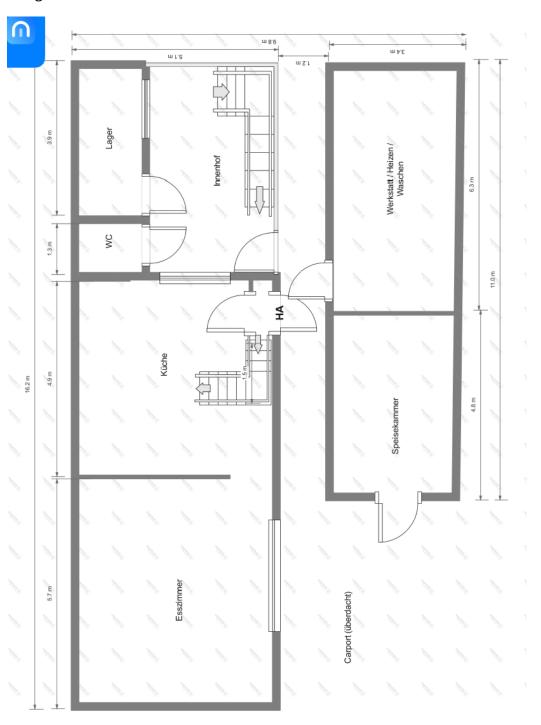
Grundriss EG, nicht maßstabsgetreu, Maße ohne Gewähr
